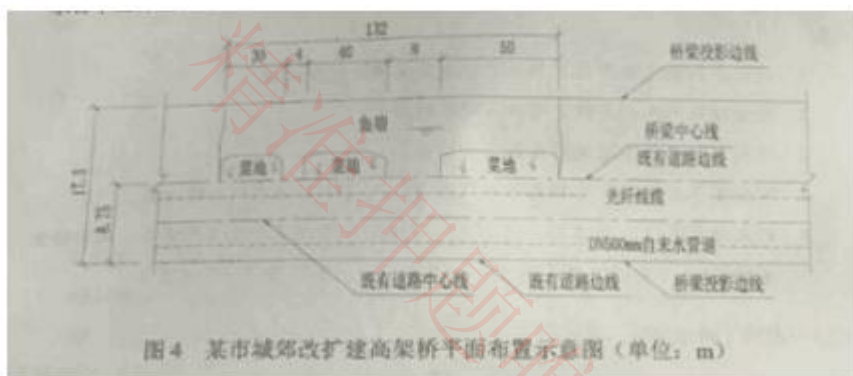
某市城郊改扩建高架桥平面布置示意图（单位：m）
